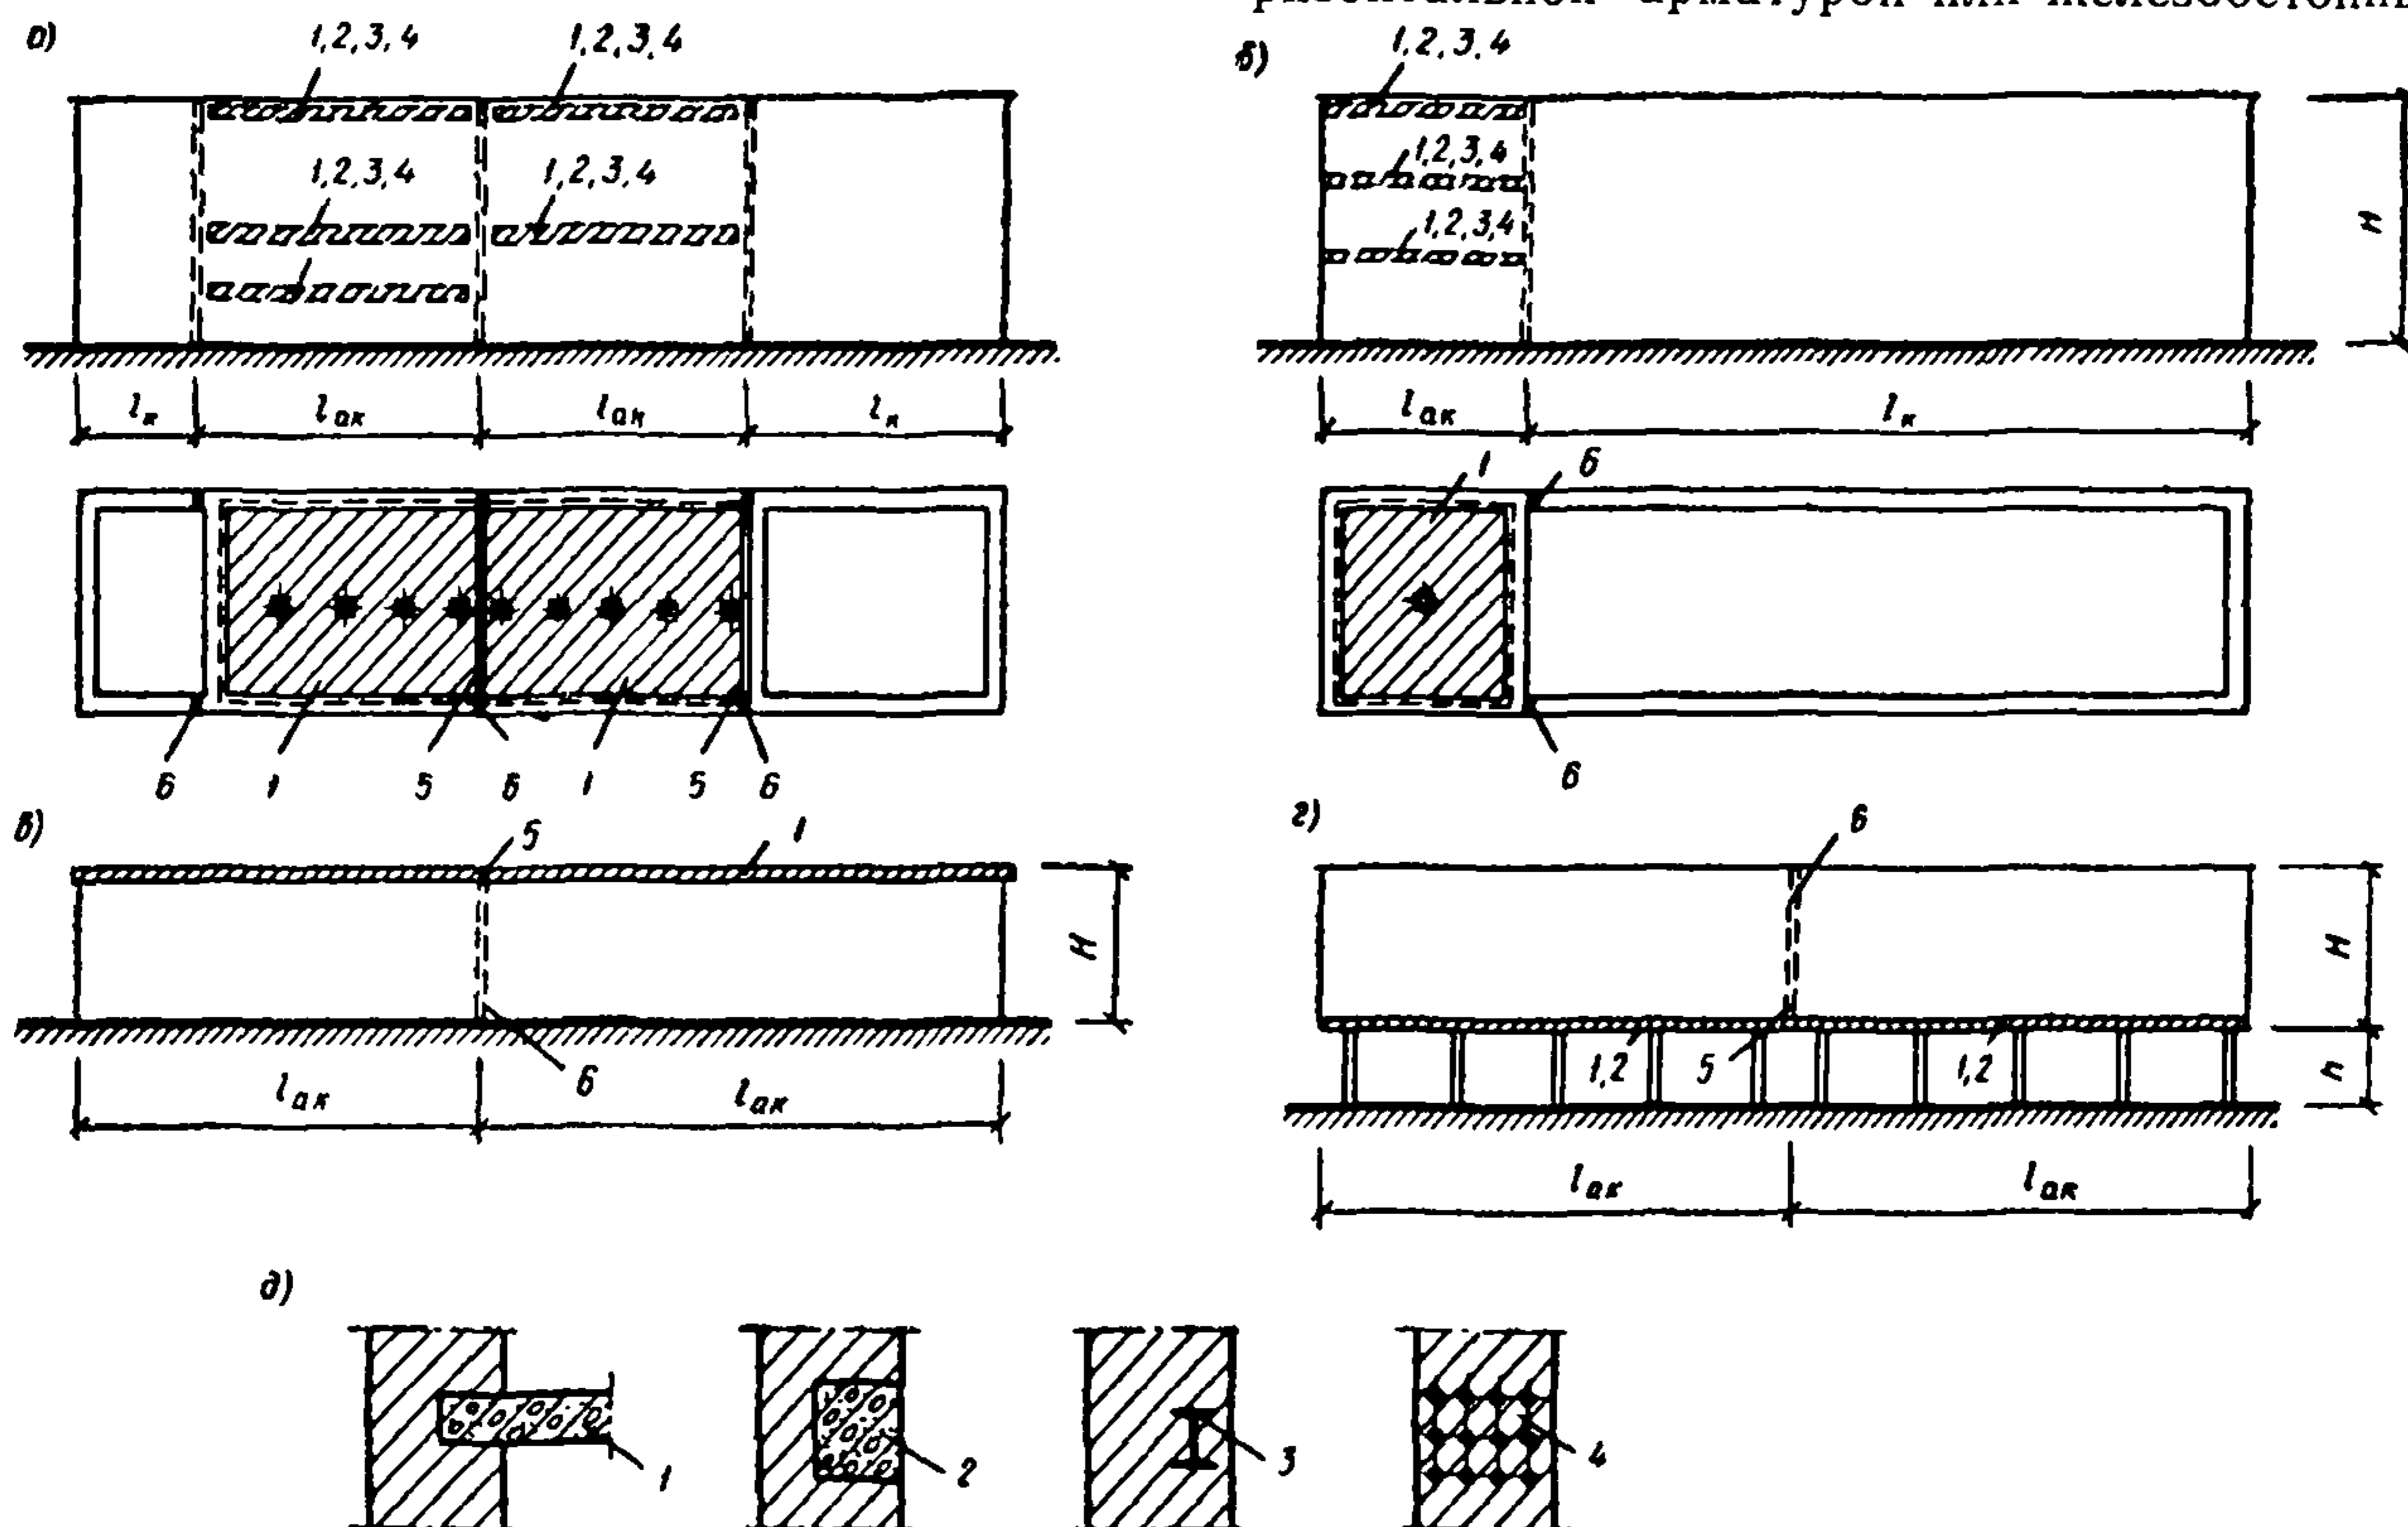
Примеры устройства температурных швов в стенах каменных зданий с армированными включениями (перекрытия, балки, армированные пояса)
